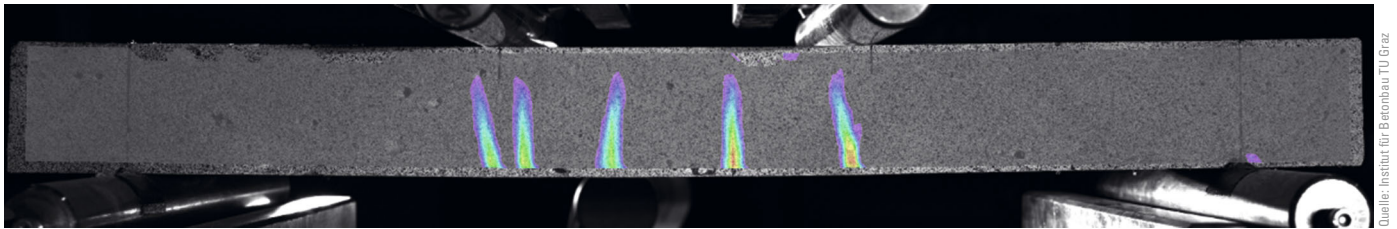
Rissbild bei einer Testplatte bei Erreichen des 1,4-Fachen der Risslast
